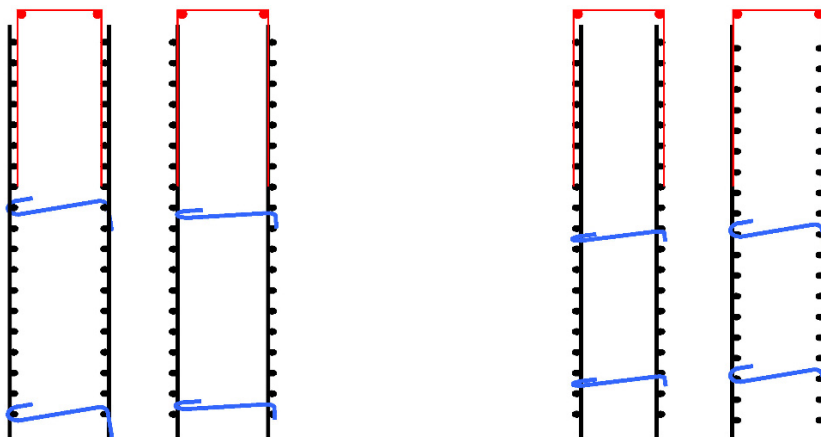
Vertikales Plattengeflecht mit einliegender Biegeform 10 (links) und umfassend (rechts)
